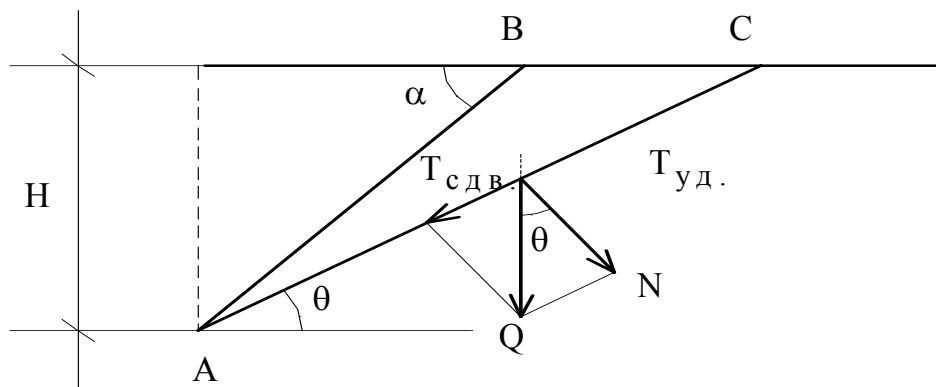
Схема расчета устойчивости откоса из несвязного грунта
